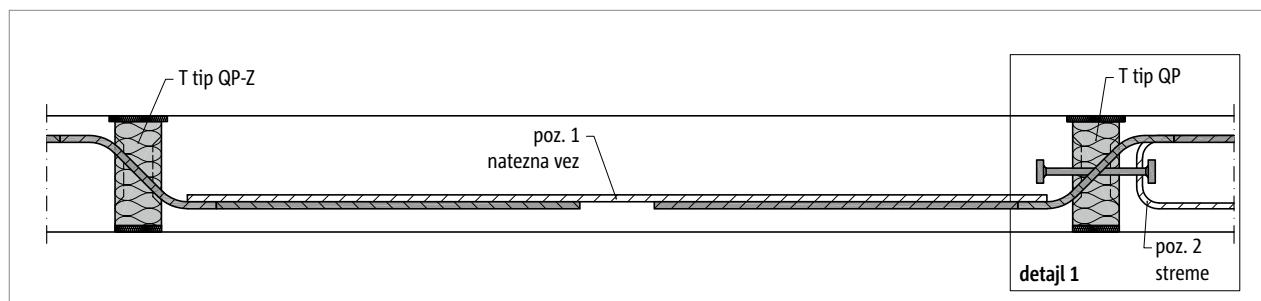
Schöck Isokorb® T tip QP-Z, QP: tloris lože
